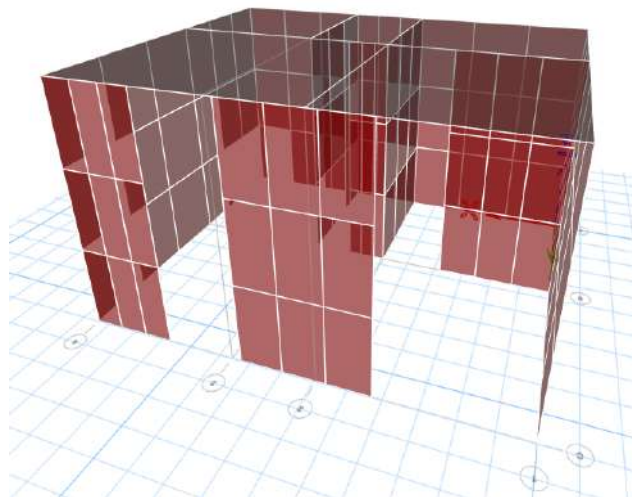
Vista en planta del modelamiento de la vivienda 14
